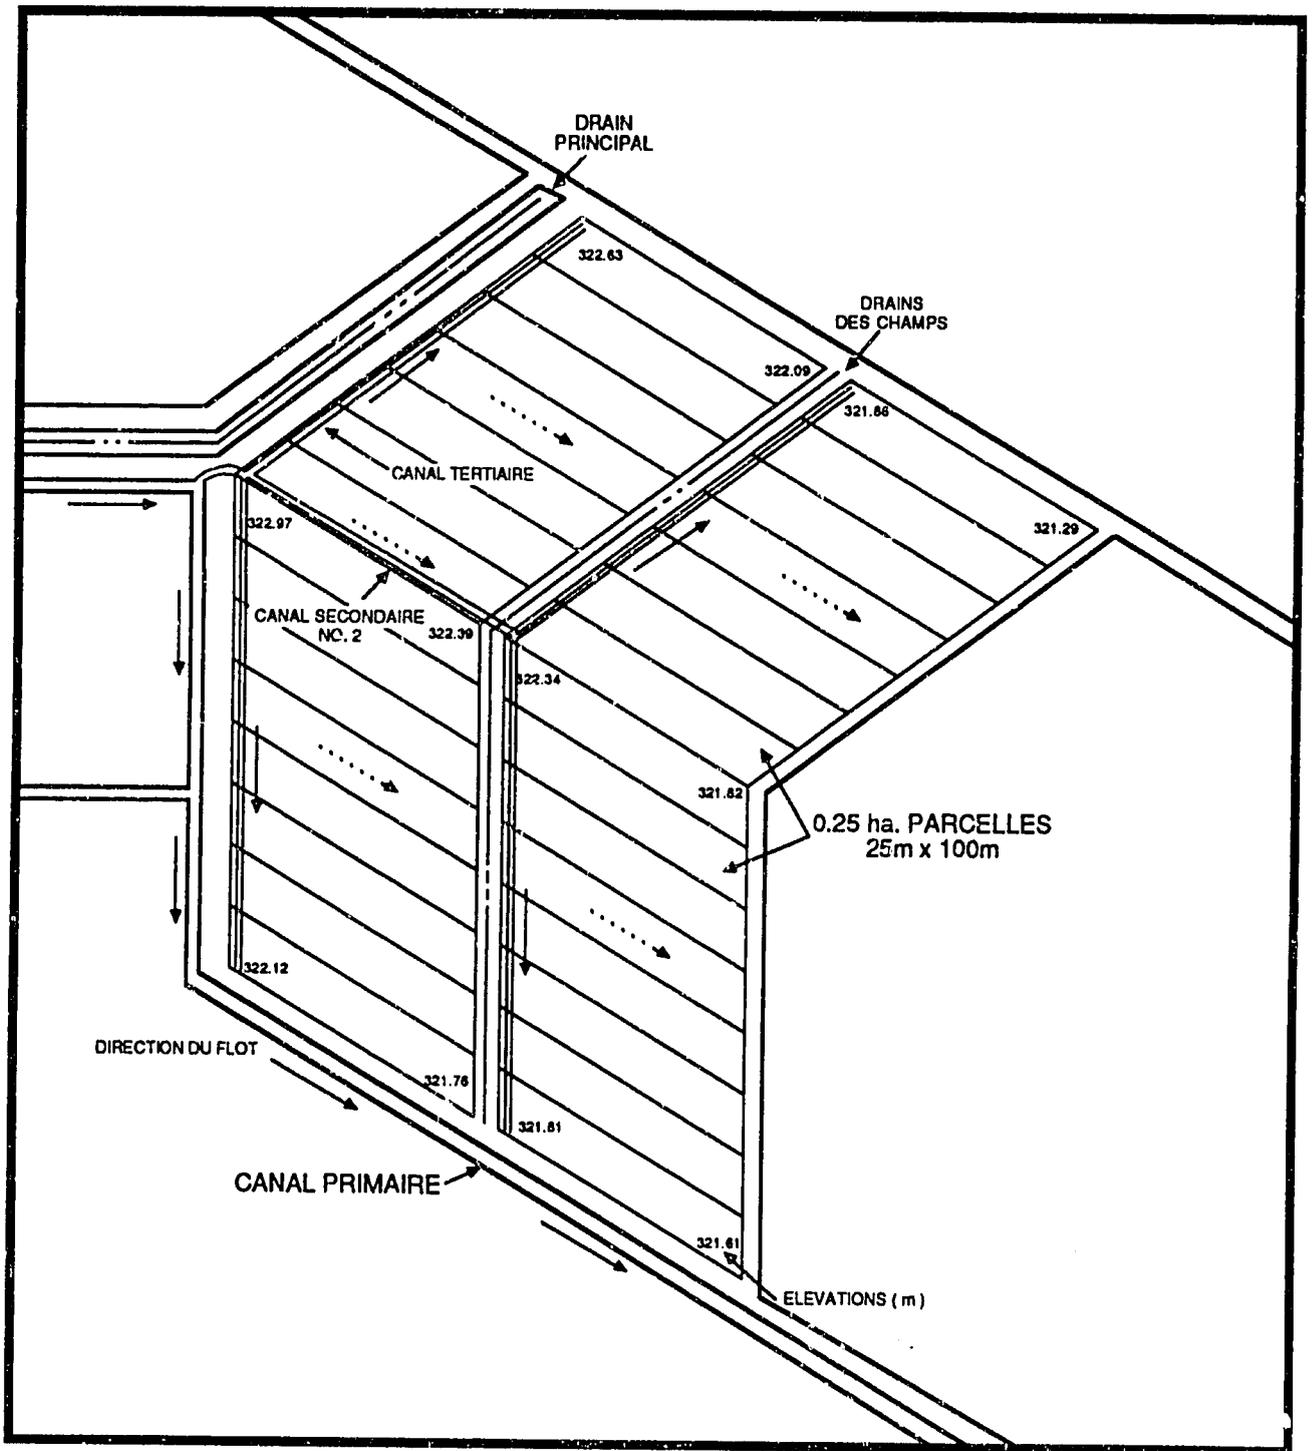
EXEMPLE D'UNE SURFACE DESSERVIE PAR LES CANAUX SECONDAIRES.
